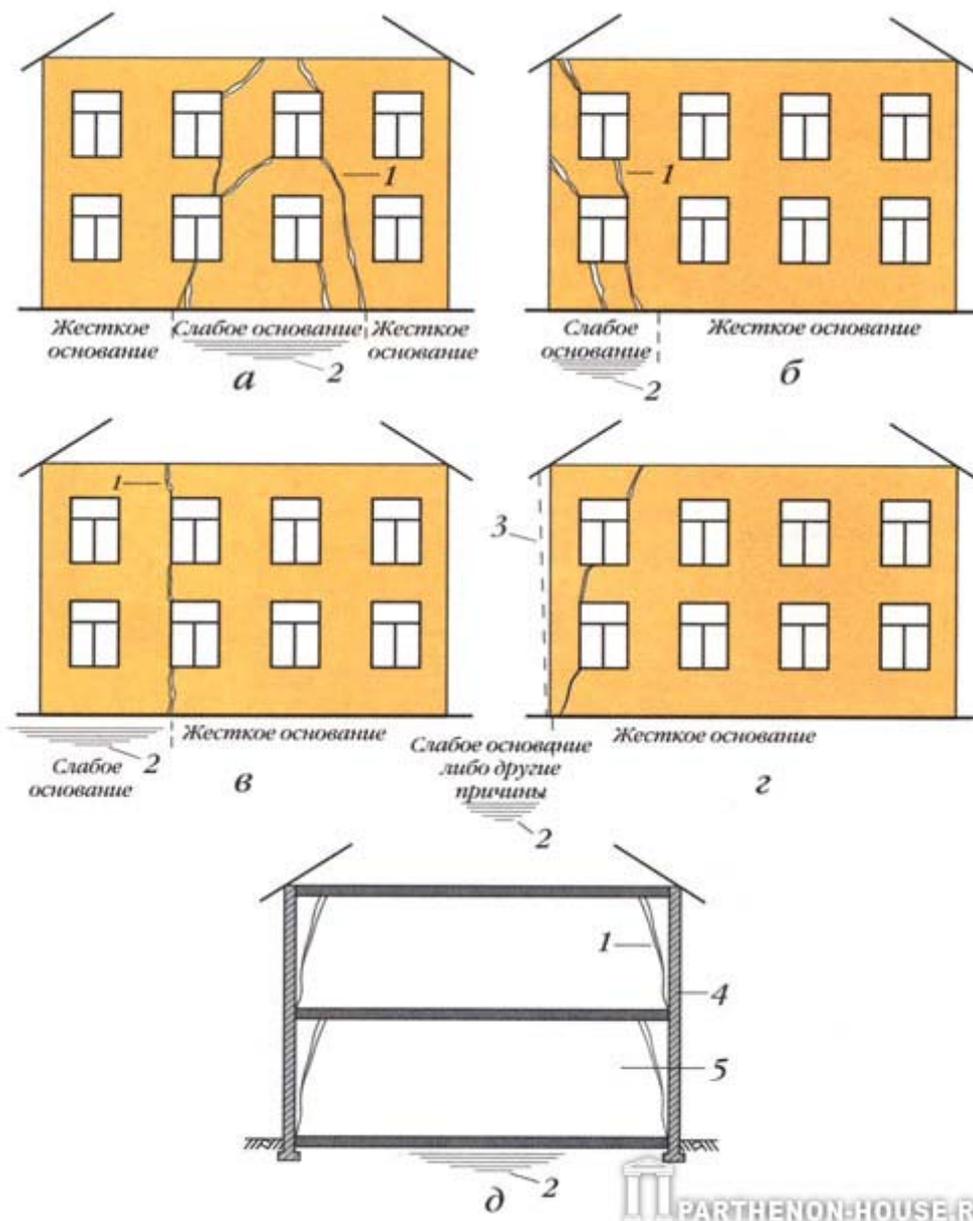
Причины образования трещин в стенах здания: а – осадка спелней части здания; б – осадка крайней части здания; в – осадка части здания (образование трещины постоянной величины по всей высоте здания); г – отклонение стены от вертикали; д – пазнипа в осадках пересекающихся стен (внутренних и наружных):
